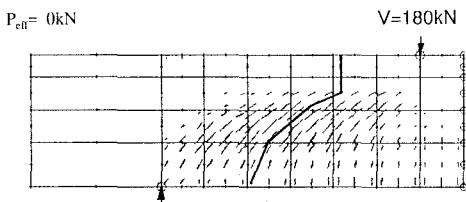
ひび割れ性状と抵抗断面（供試体PP）
